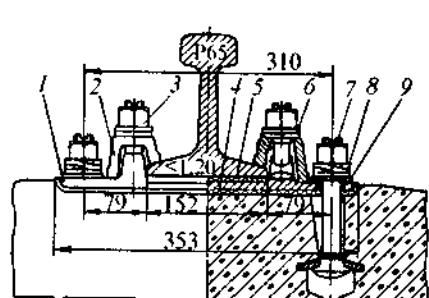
Раздельное клеммно-болтовое скрепление для железобетонных шпал:
